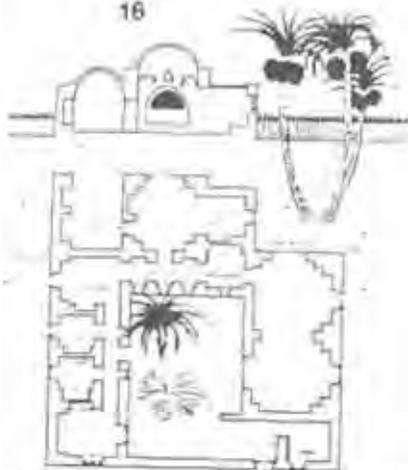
Grundriß und Schnitt von Hamed Saïd's Haus, 1942-1945 gebaut.
